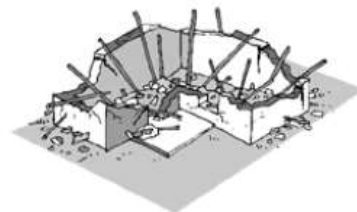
Caída de la cubierta hacia el interior de la vivienda
